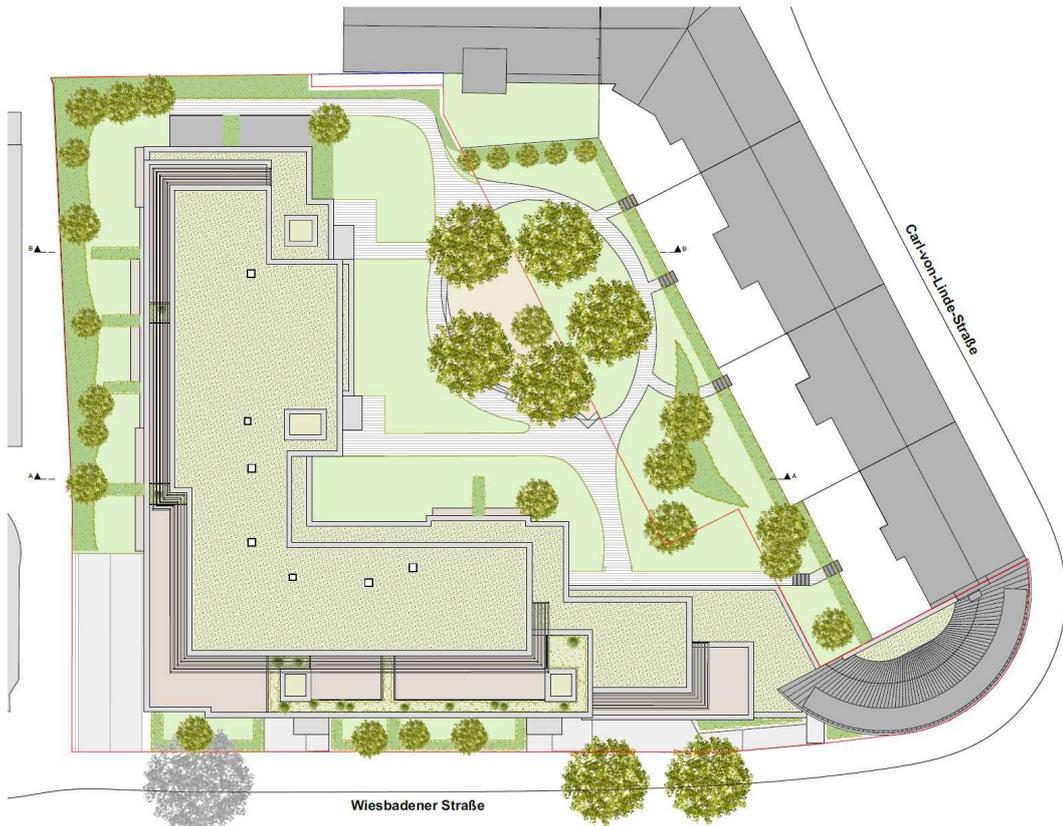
Lageplan mit Dachaufsicht, Vorhaben- und Erschließungsplan (Infra Architekten September 2020, ohne Maßstab)
